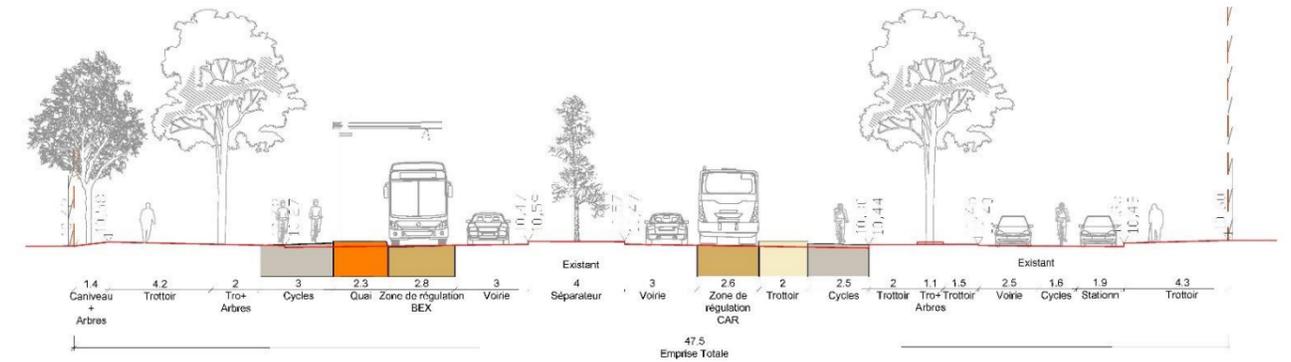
Coupe type sur la rue Générale de Larminat en section courante
